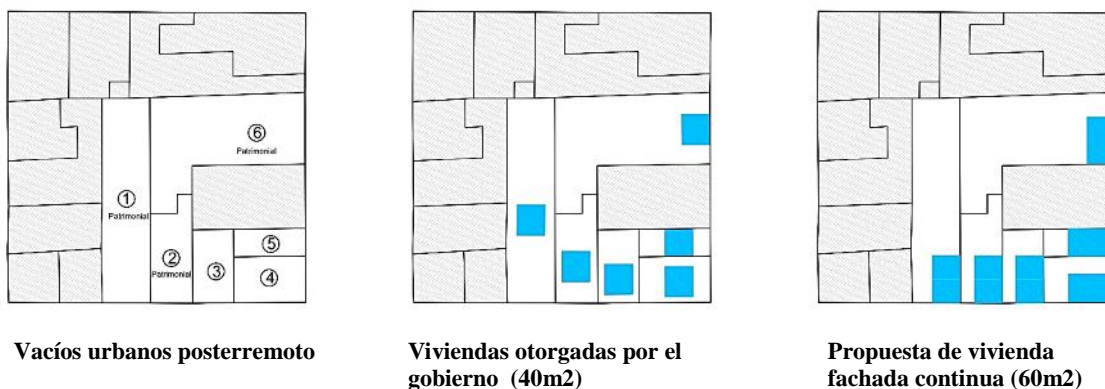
Esquemas de implantación de viviendas posterremoto. Fuente: Elaboración propia
